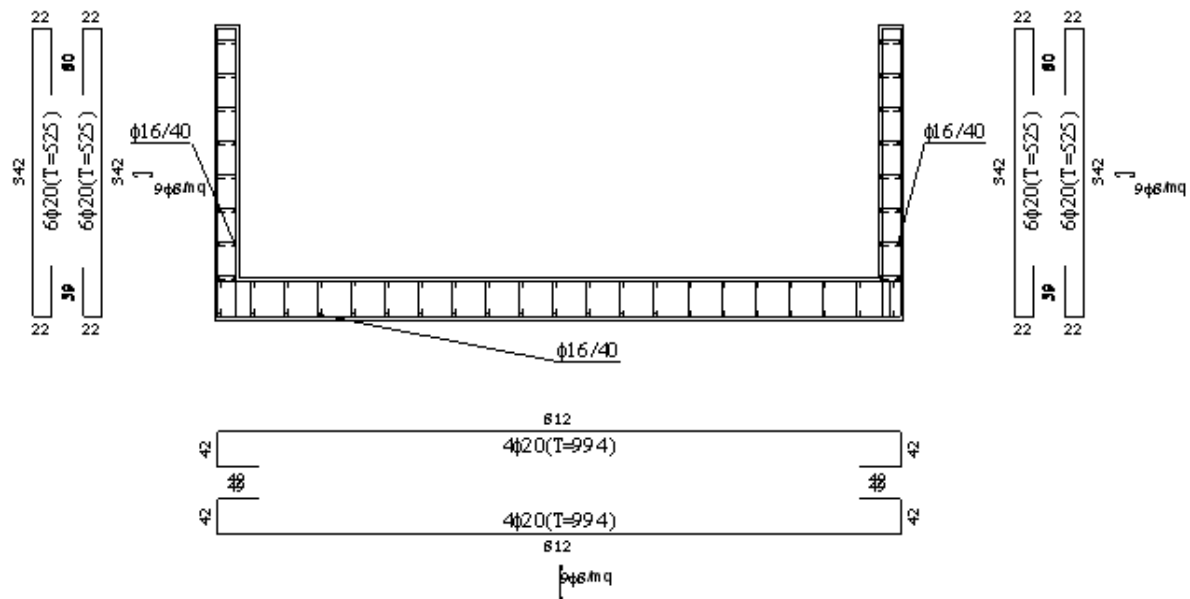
Schema delle armature, sezione tipo 1 dell’opera di scarico
